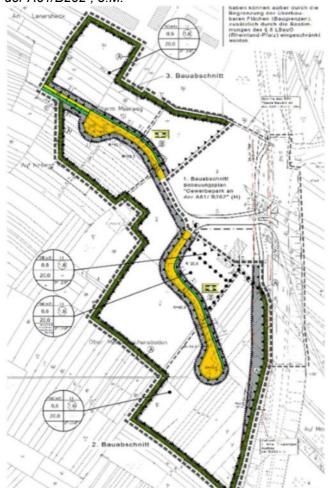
bestehender Bebauungsplan "1. Änderung und Erweiterung des Gewerbeparks an der A61/B262", o.M.
